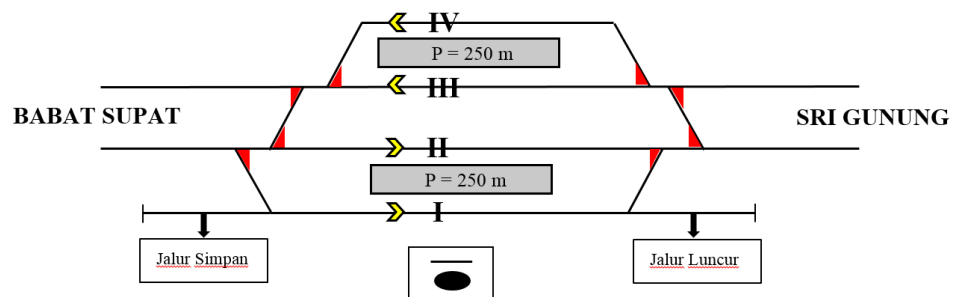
Track Layout* Stasiun Babat Supat
